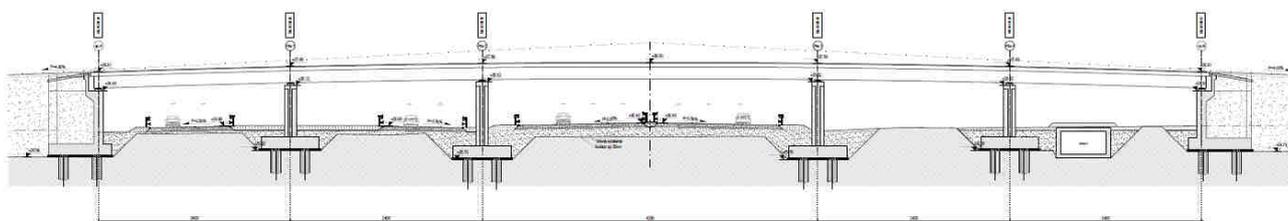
Profilo longitudinale Cavalcavia Svincolo Baracca Manna
